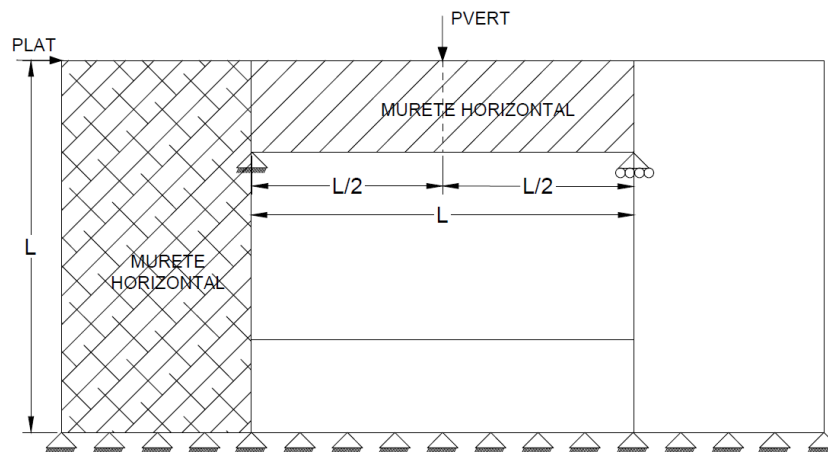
Muro de adobe adoptado como muretes vertical y horizontal. (Chacón, Suquillo, & Sosa, 2021)
